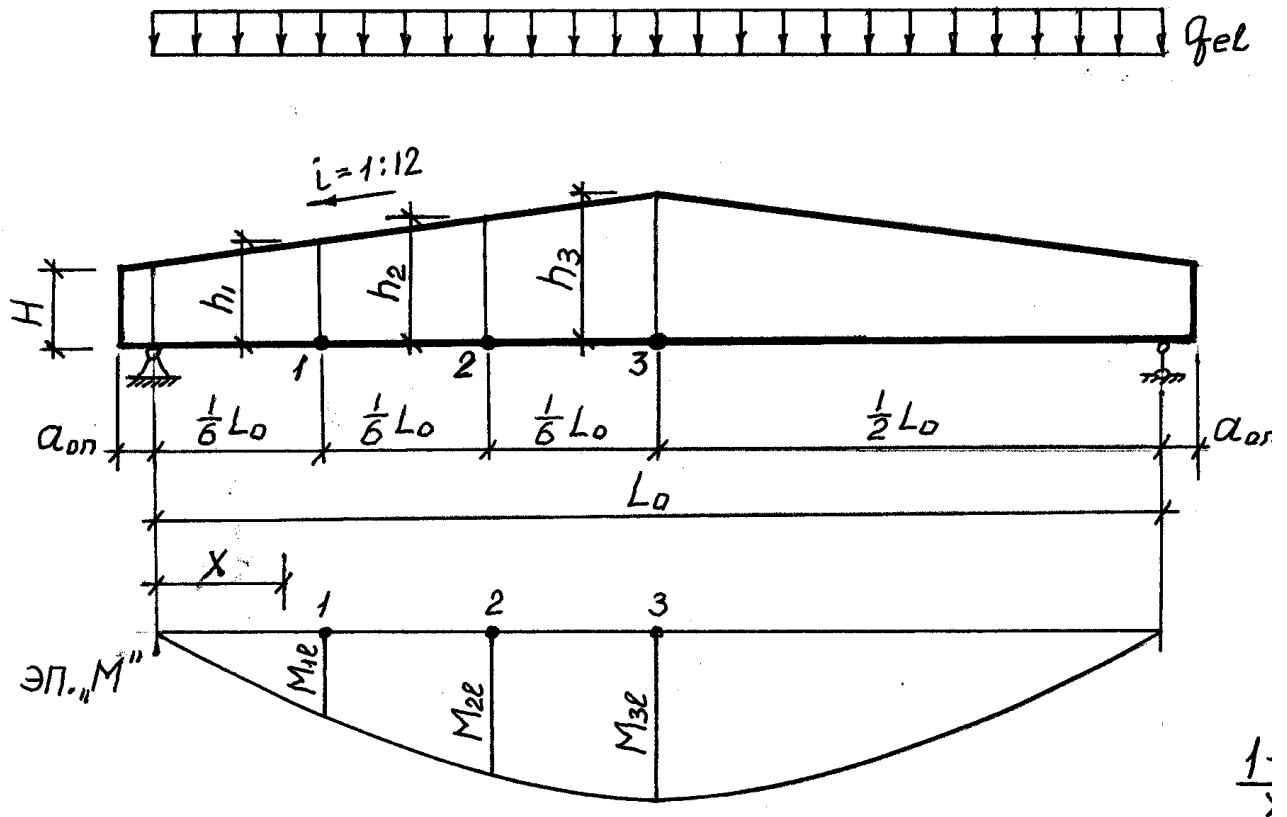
Розрахункова схема балки при визначенні прогину f
